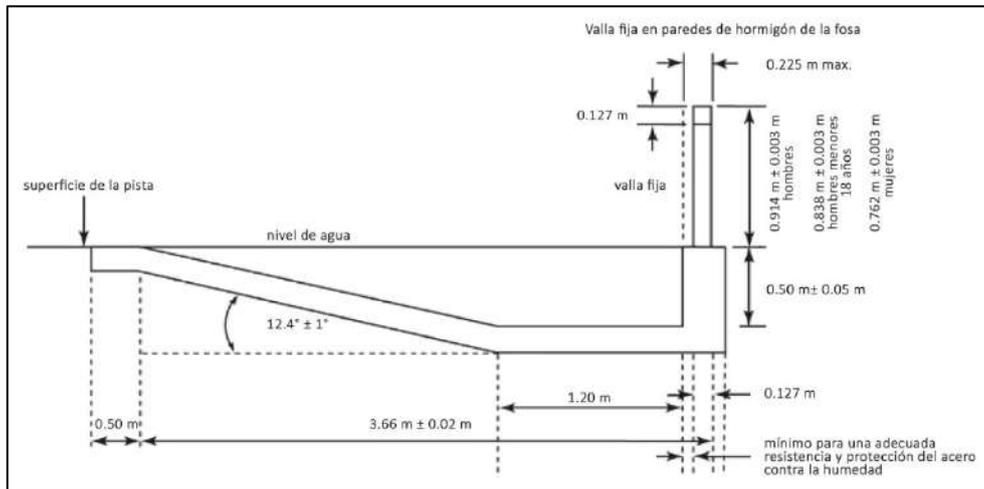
Detalle de valla fija para Salto de agua en pista de obstáculos (Dimensiones en m)
